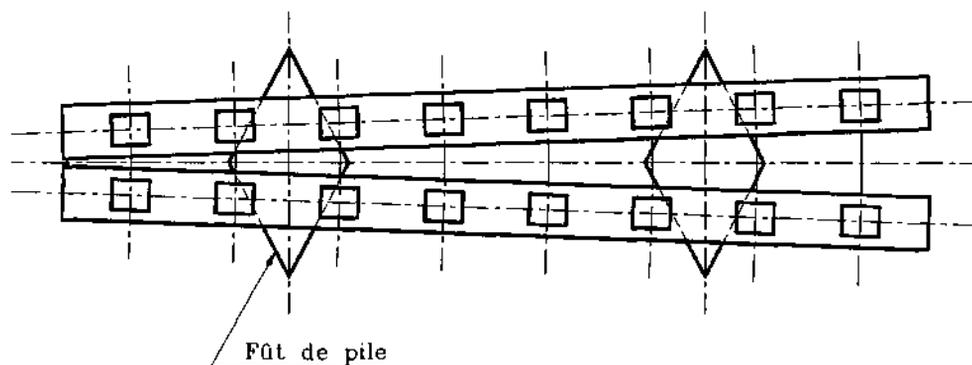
Disposition des travées d'un ouvrage courbe
